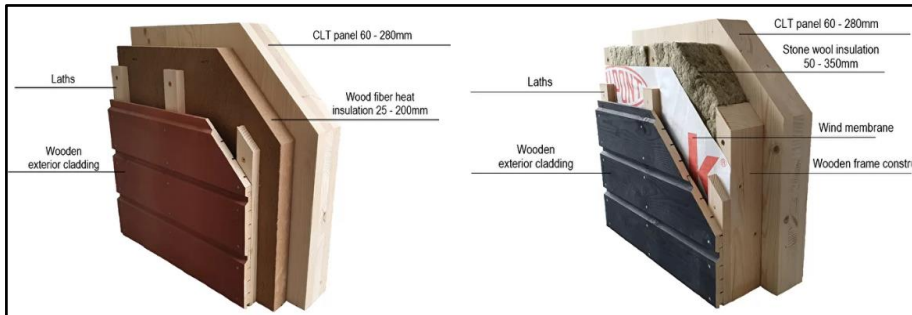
CLT panel mobil konut-Cubist Engineering [94]
